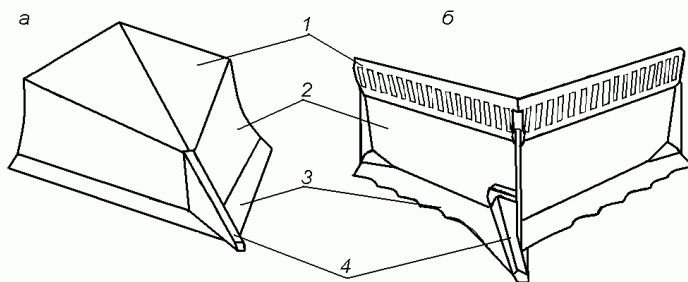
Клиновидный (а) и двухкорпусный (б) кусторезные отвалы:
